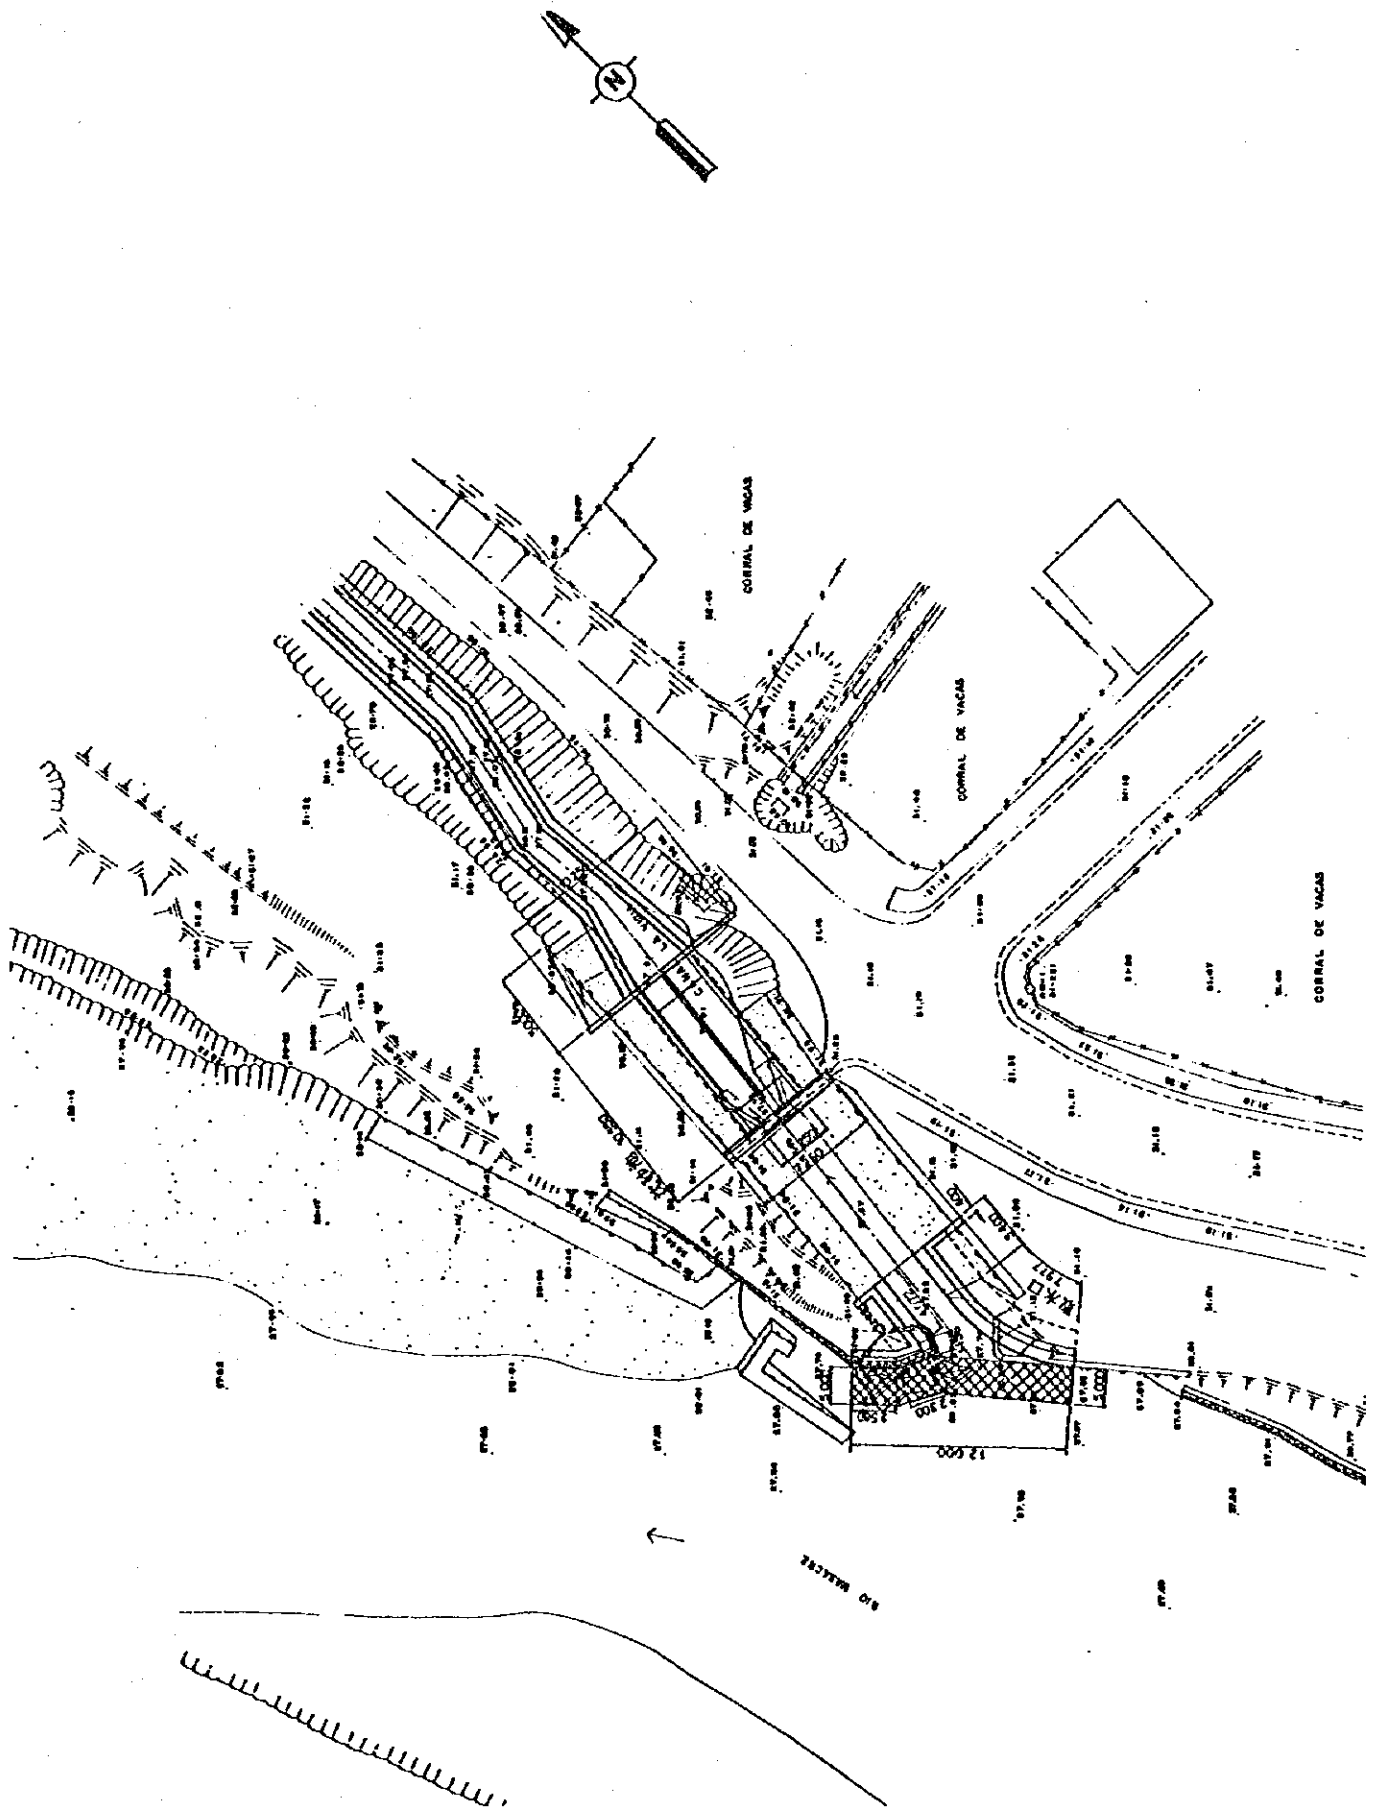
取水口、ゲート、沈砂池計画平面図
